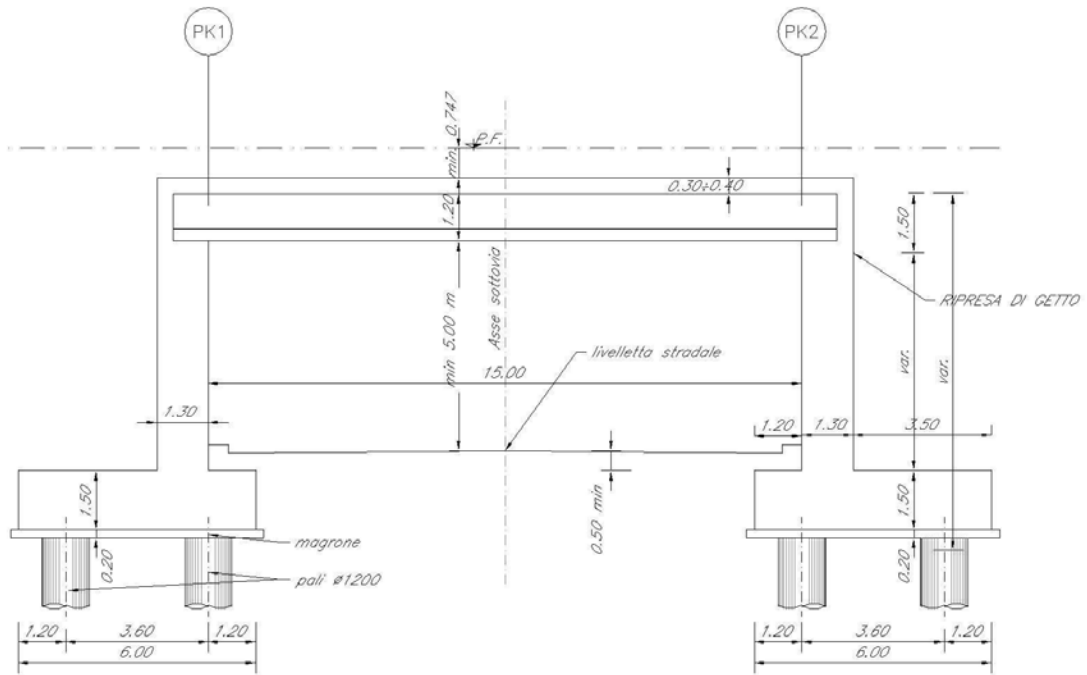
Prospetto in corrispondenza di attraversamento stradale.
